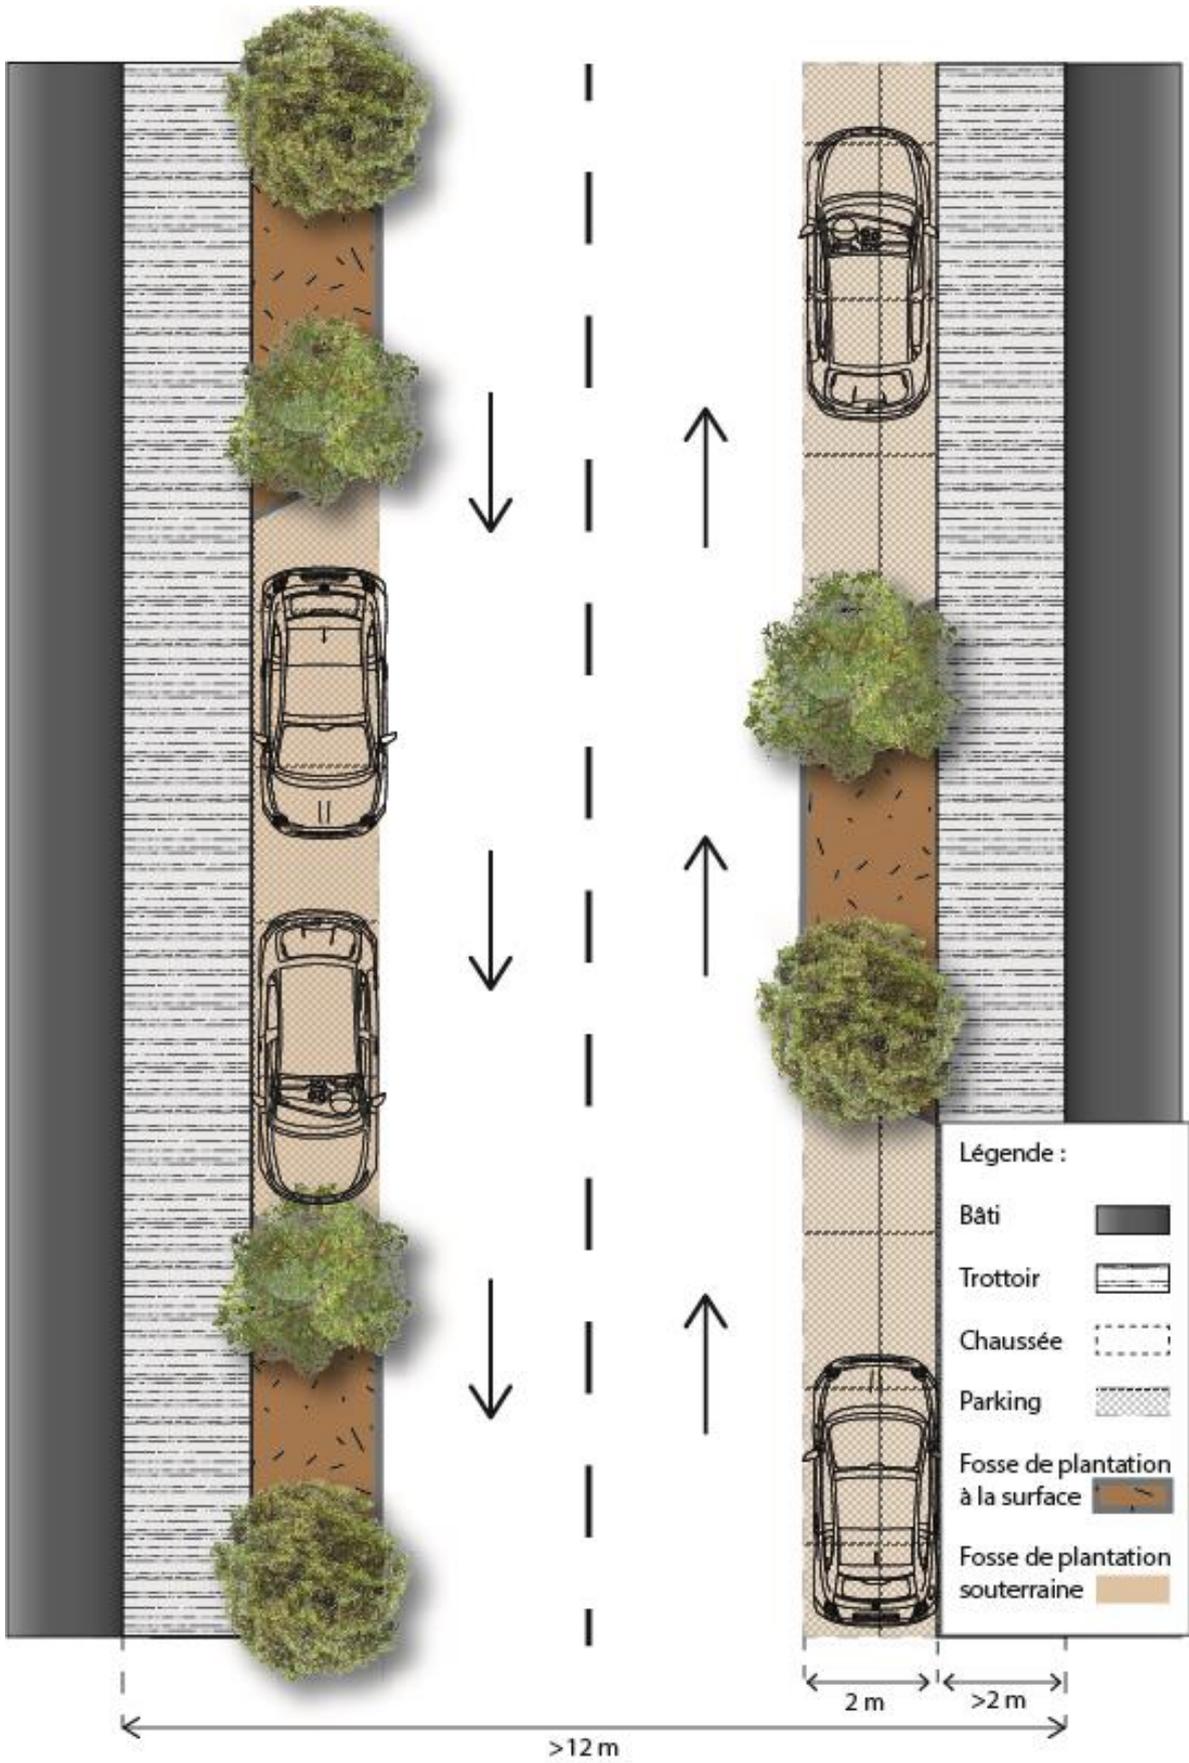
Exemple de plan de voirie double sens avec extension de la fosse en tranchée sous les places de parking. (M. Cornut, 2020)
